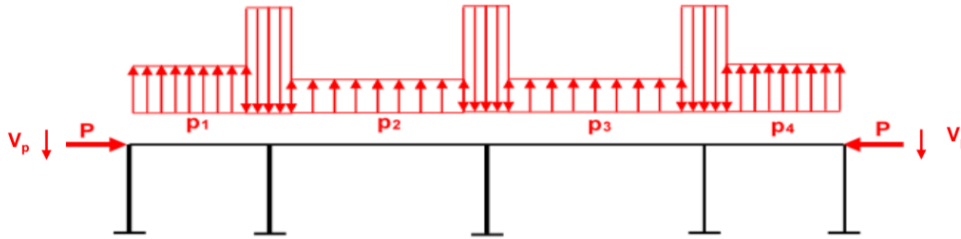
Esquema de fuerzas proporcionado por el pretensado
